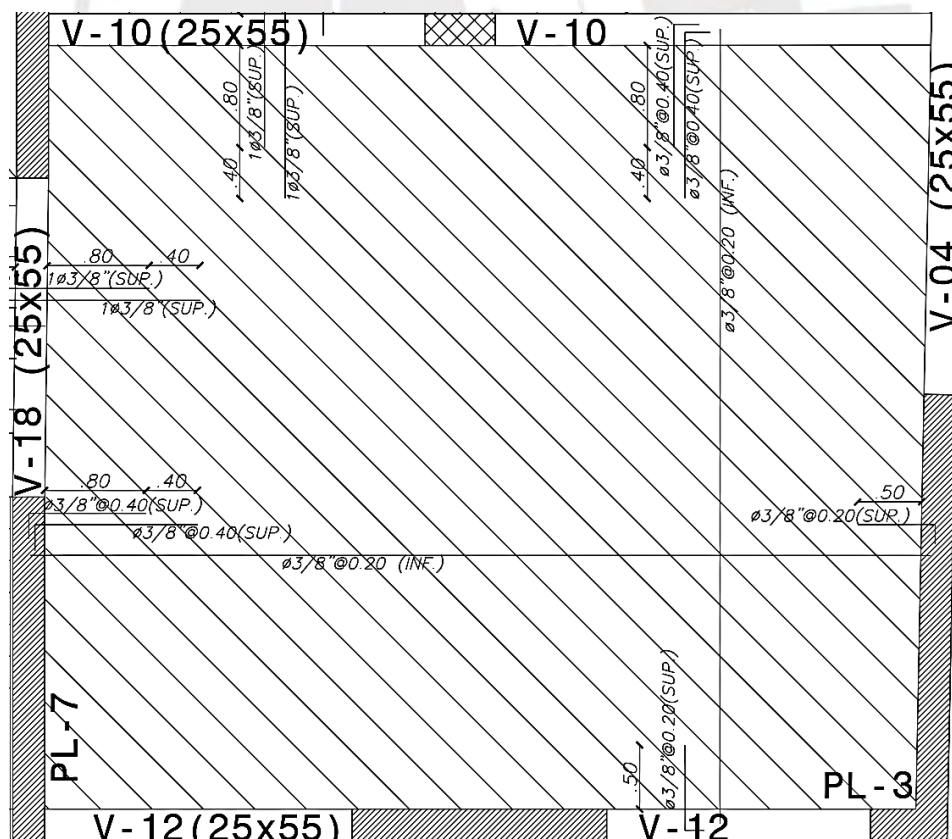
Planta con refuerzo de diseño de la losa maciza eje C'-E/4-6
